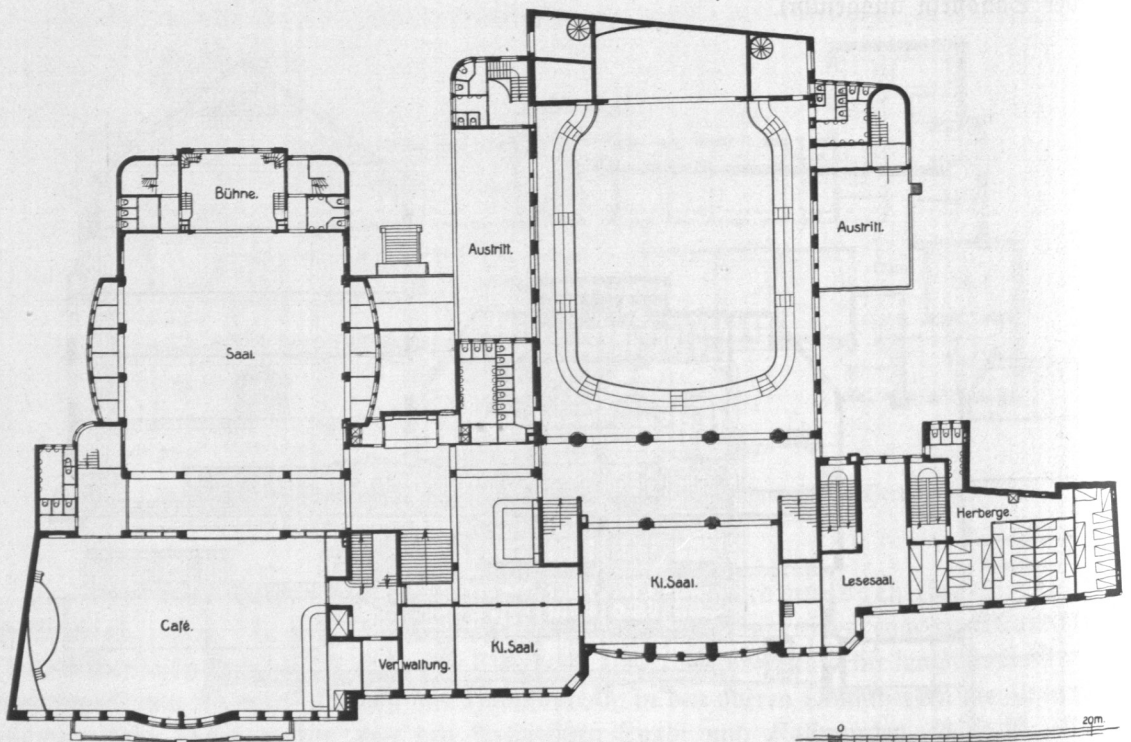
Gewerkschaftshaus, Obergeschoss, Grundriß.
